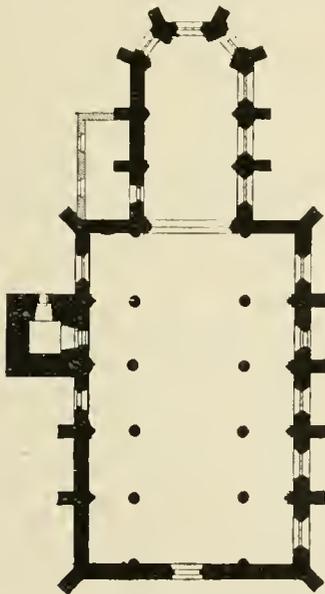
(Grundriss der Pfarrkirche in Sterzing.)
